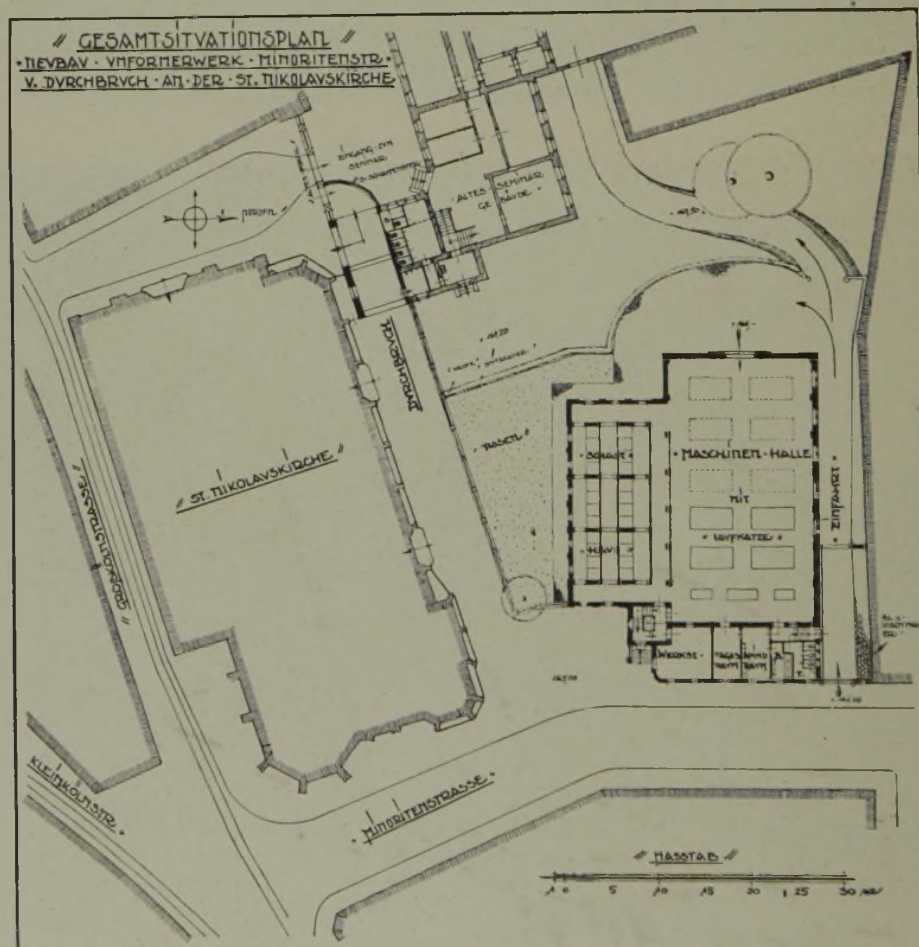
Gesamtanlageplan des Umformerwerks Minoritenstraße. (1 : 800.)
